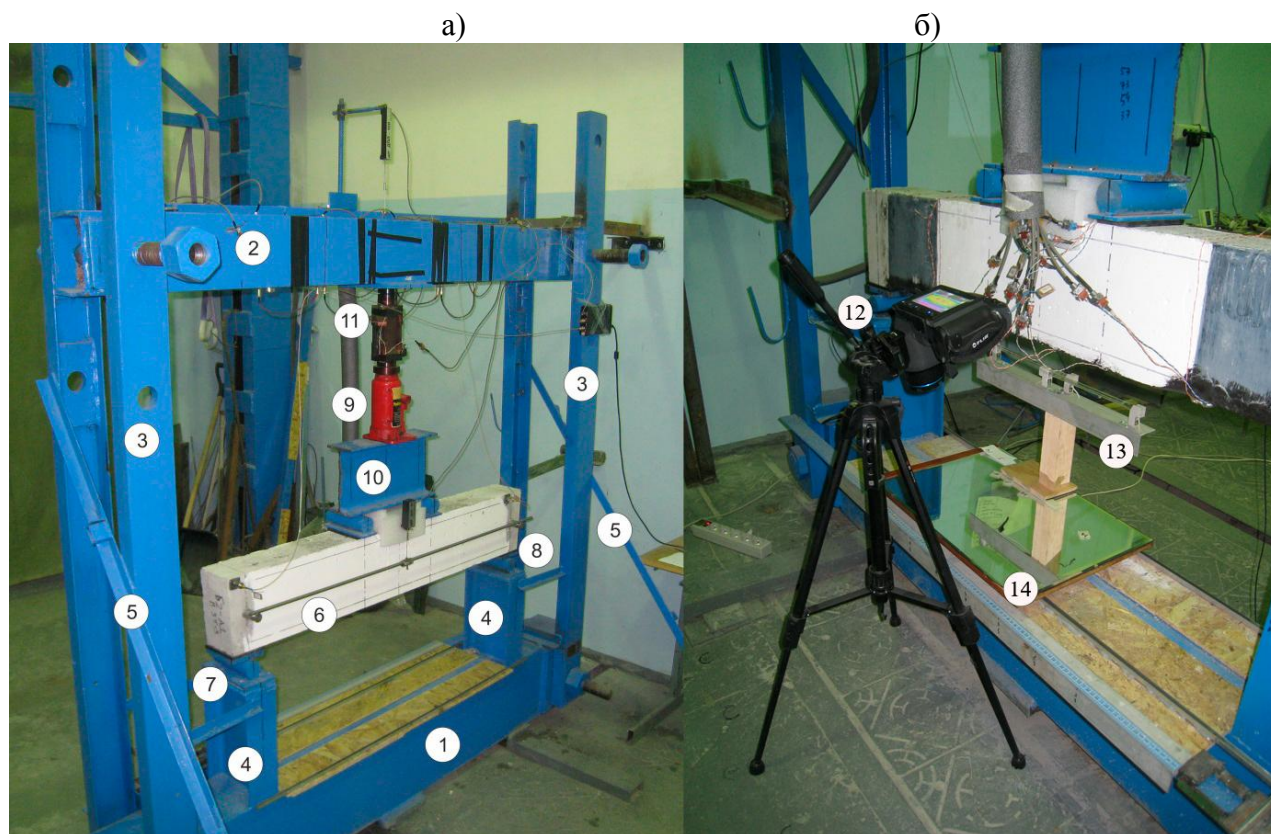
Стендовое оборудование: а) испытательный стенд, б) схема инфракрасной съемки.
